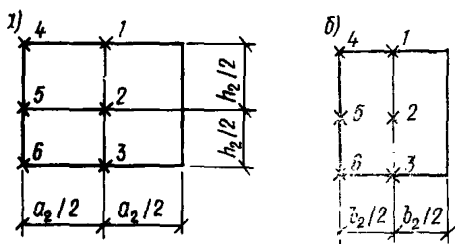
Схемы расчетных точек вертикальных стенок высоких бункеров
